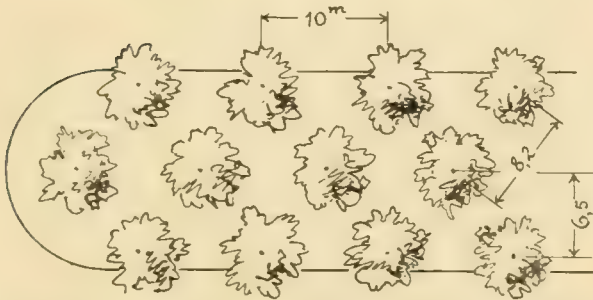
Grundriss bei dreifacher Reihenbildung mit versetzter Baumstellung.
